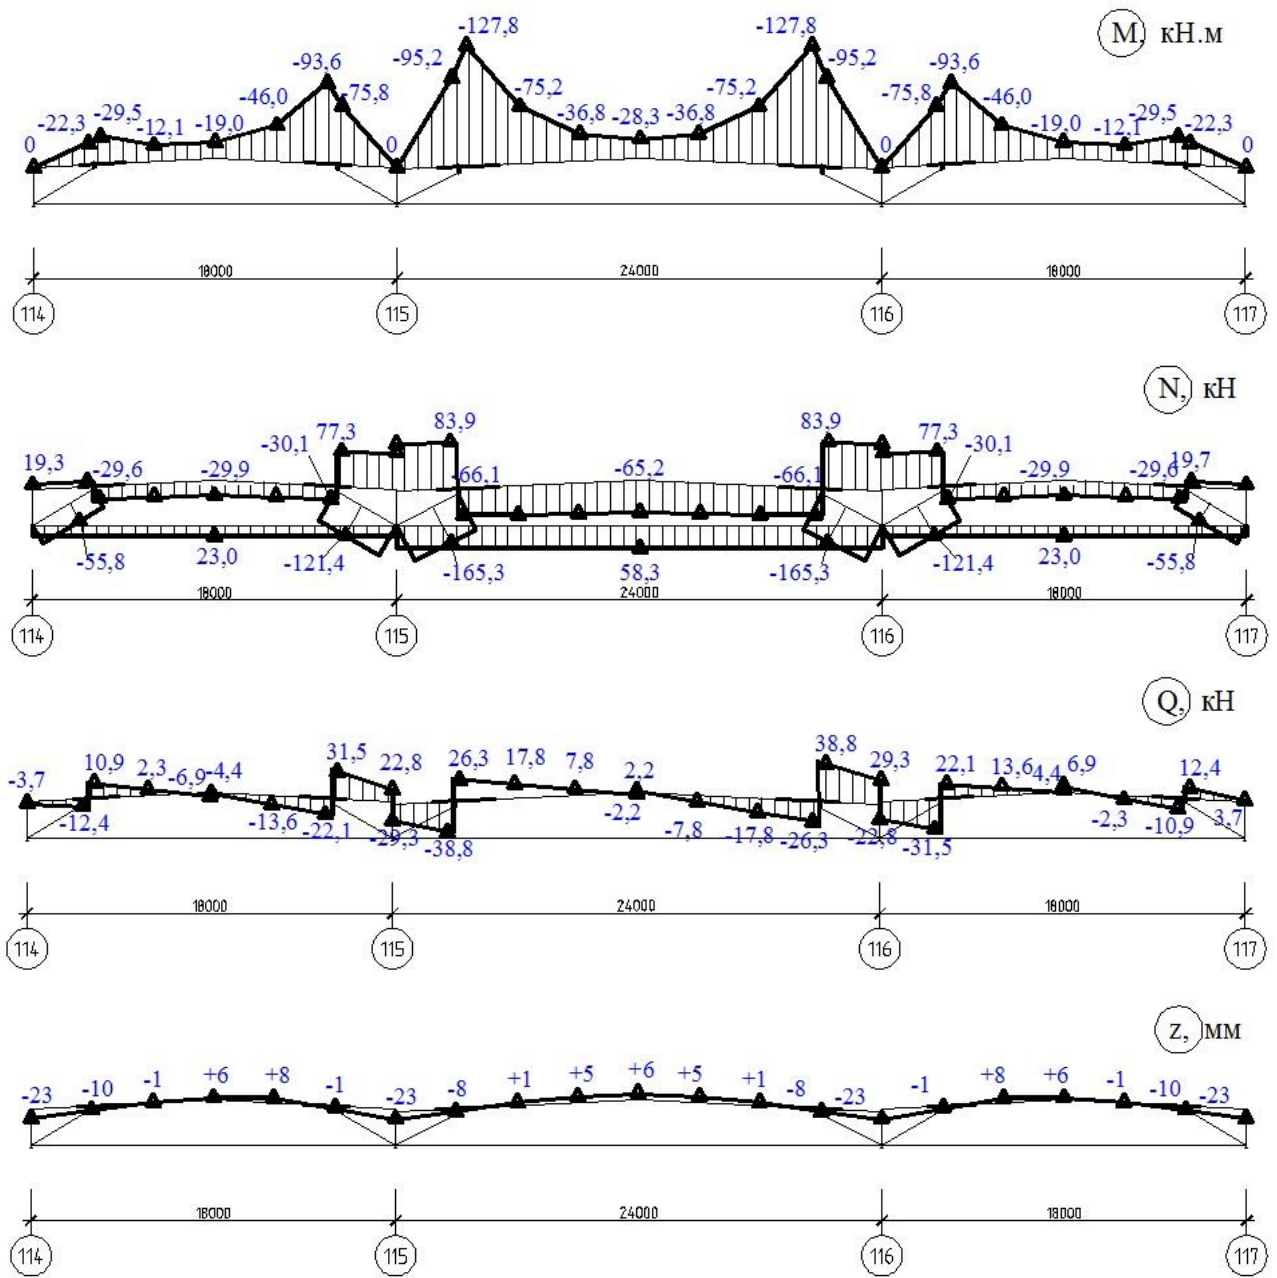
Усилия и перемещения на этапе предварительного напряжения надколонников
